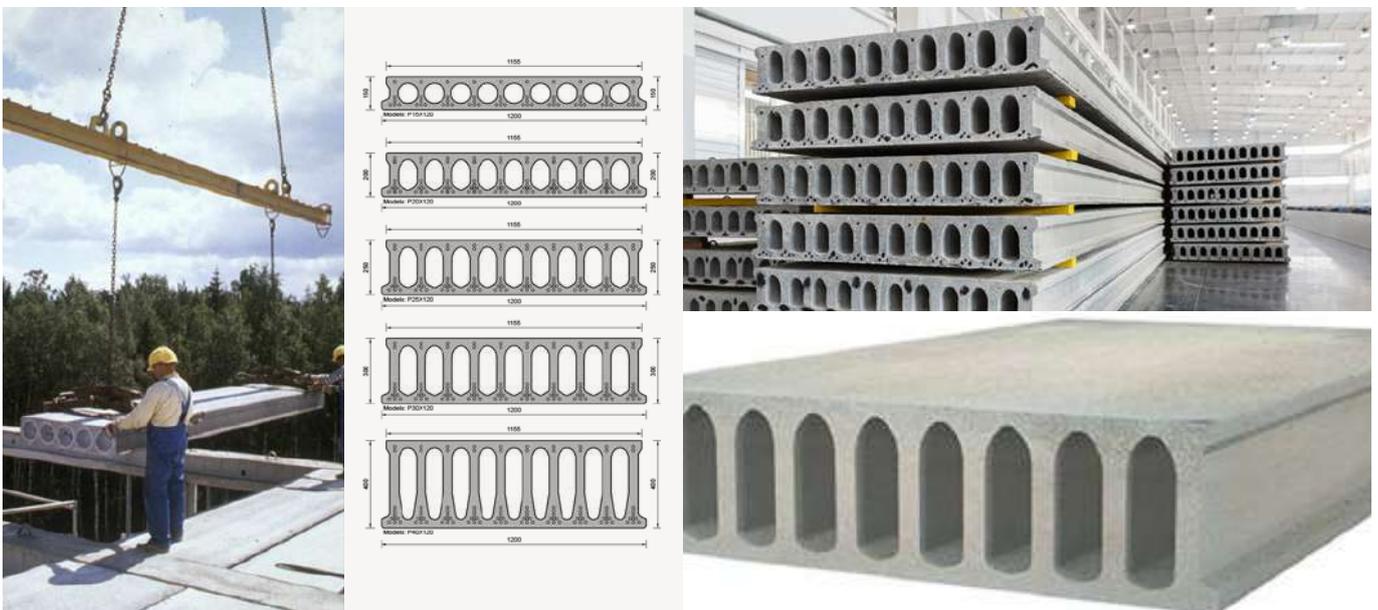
Ejemplos de placas alveolares y doble TT de hormigón prefabricado.
